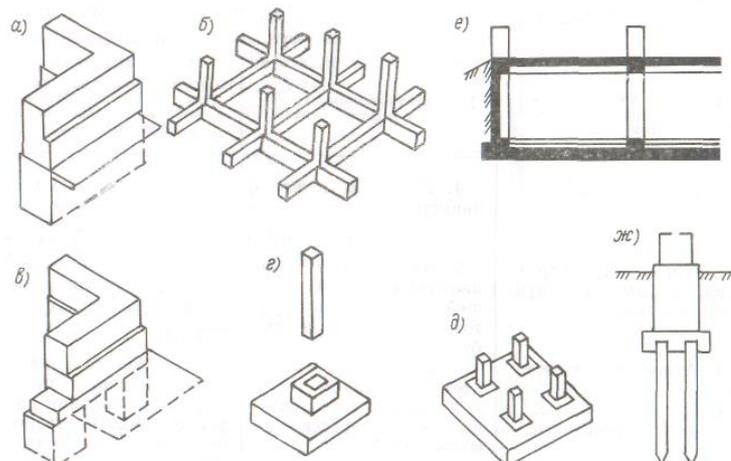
Основные конструкции фундаментов: а – ленточный под стены; б – то же, под колонны; в – столбчатый под стены; г – отдельный под колонну; д – сплошная плита под колонны; е – коробчатый под здание; ж – свайный
